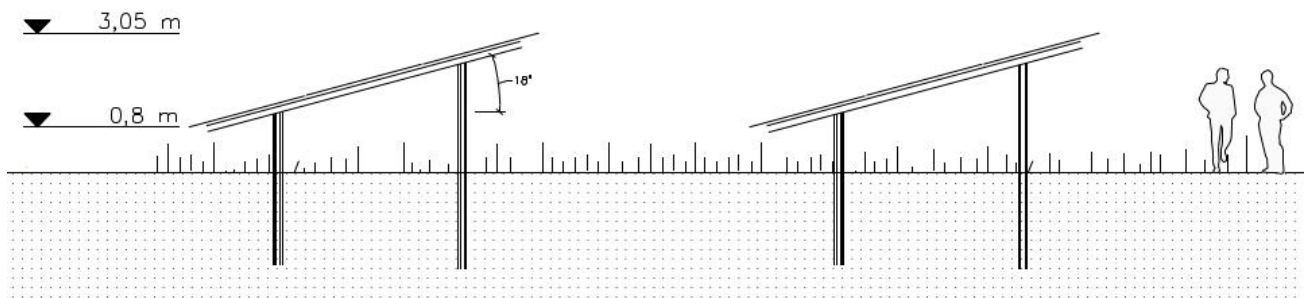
Skizze des Gebäudes mit PV Modulen (Quelle: Planungsunterlagen)
